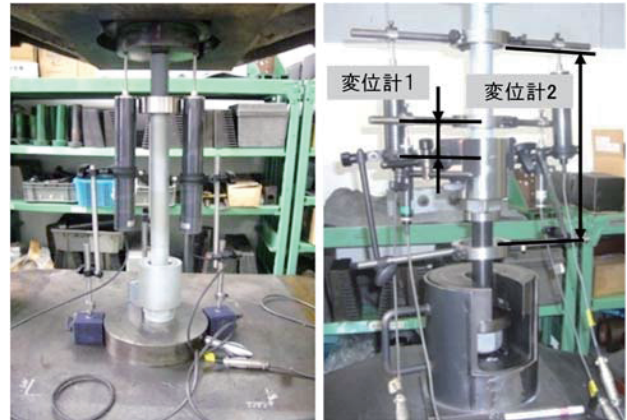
押し込み試験状況 写真-2 引抜き試験状況
